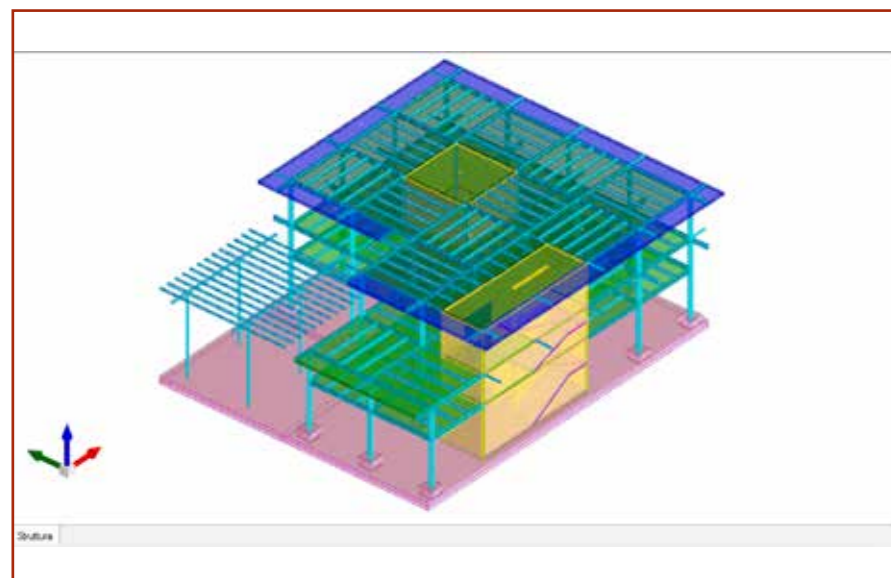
Rappresentazione generale della struttura - vista 2.png
